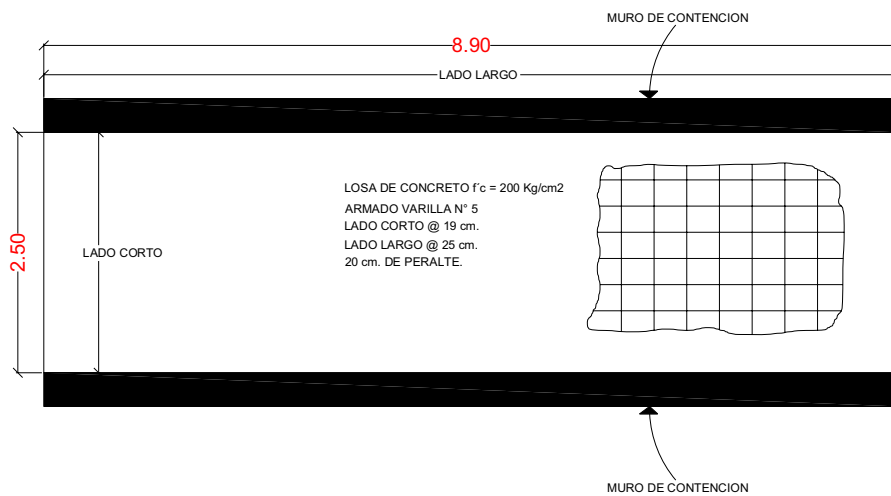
, Resultados obtenidos para la losa de concreto armado.
